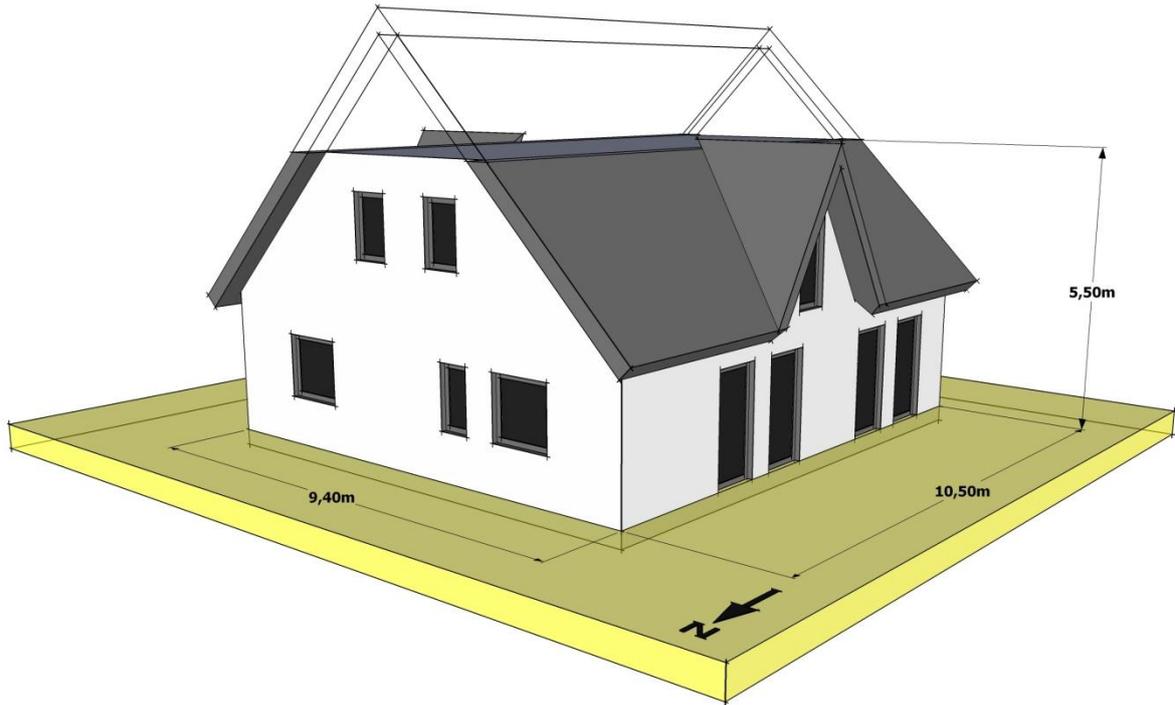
Einfamilienhaus klein – Ansicht Nord-West
